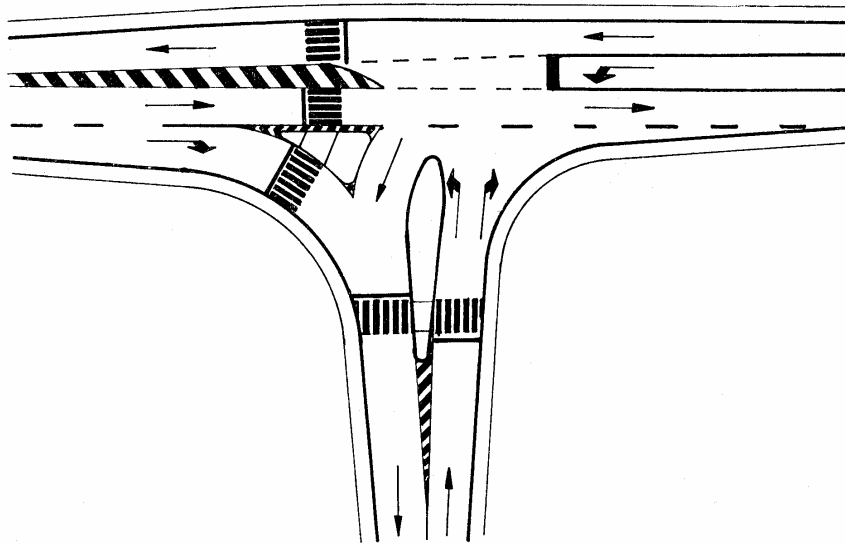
Amenajarea unei traversări pentru pietoni.
